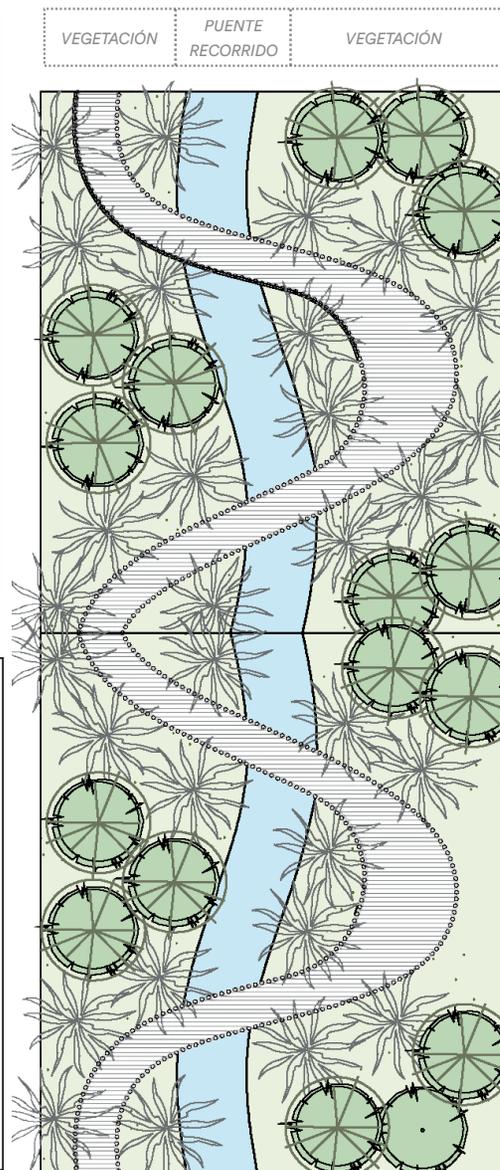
Planta modular escala 1:200 recorrido ecológico (puente). Elaboración propia
